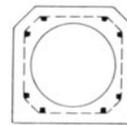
Konstruktion eines betonbemantelten Pfahles.
